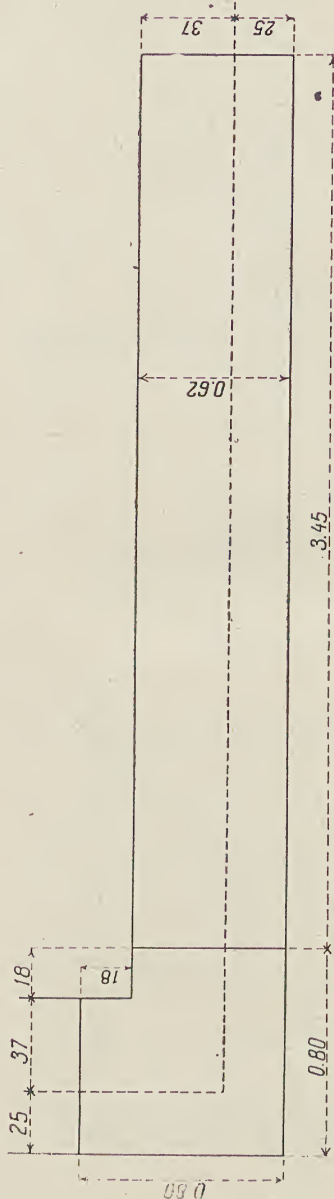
et 727. — Calepin de l'entablement de la façade principale, partie de gauche. — Plan et coupe
